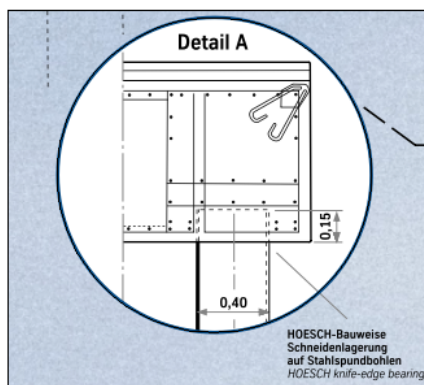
Detail A: Hoesch-Bauweise Schneidenlagerung; Quelle: bt.thyssenkrupp-bautechnik.de
